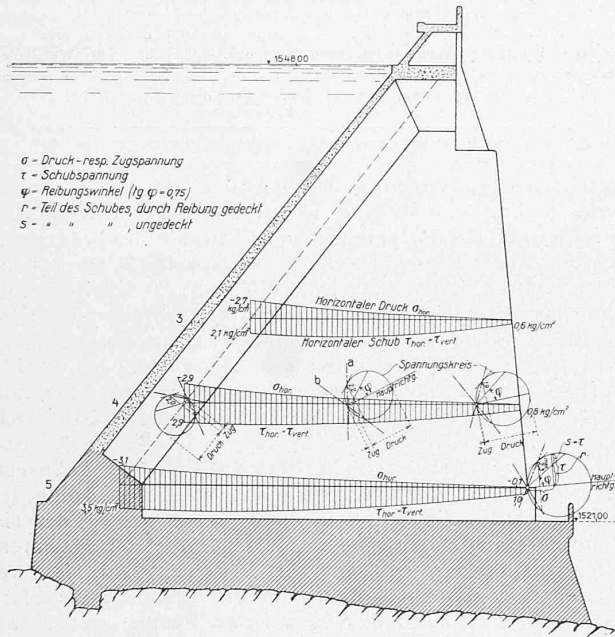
Spannungszustand eines Pfeilers. (Mauermaßstab 1 : 400.)
